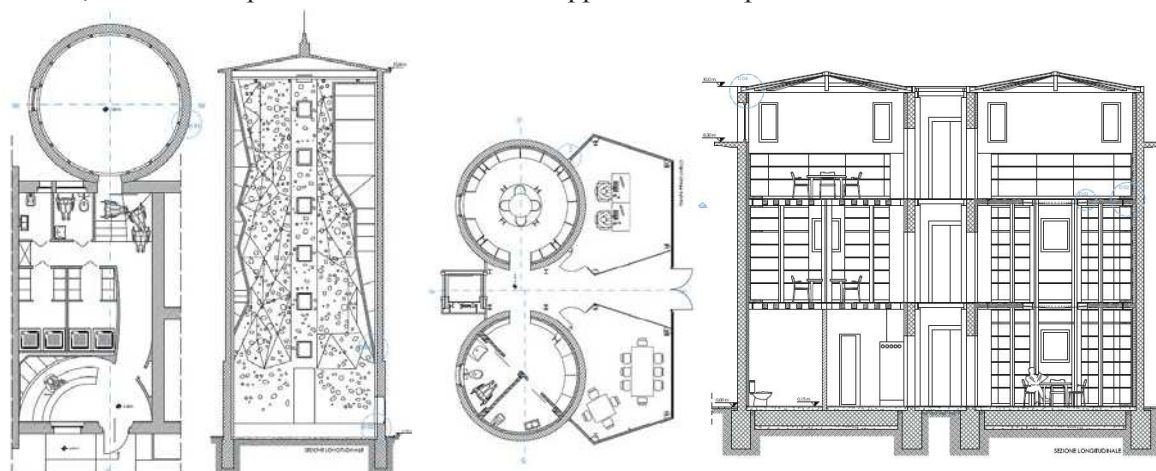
Pianta e sezione del centro arrampicata e della sala lettura.
